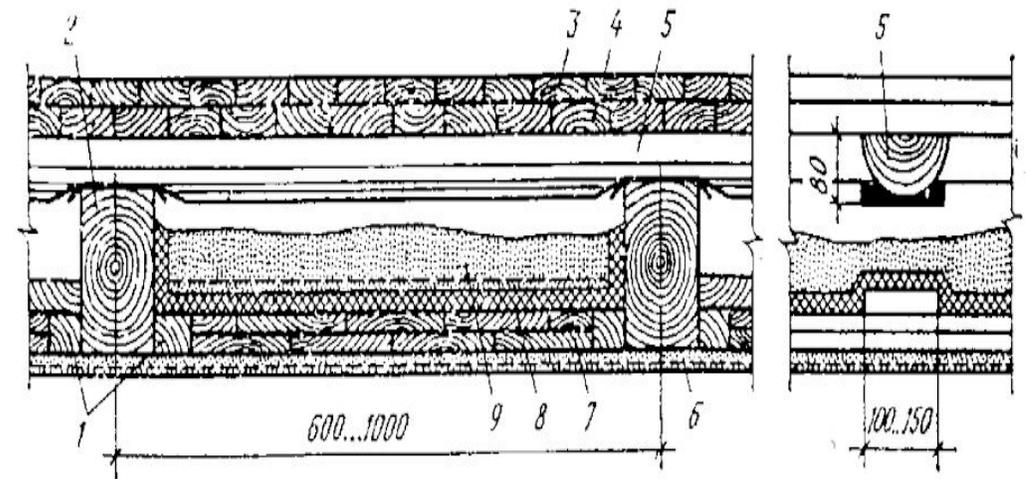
Конструкция деревянного междуэтажного перекрытия:
